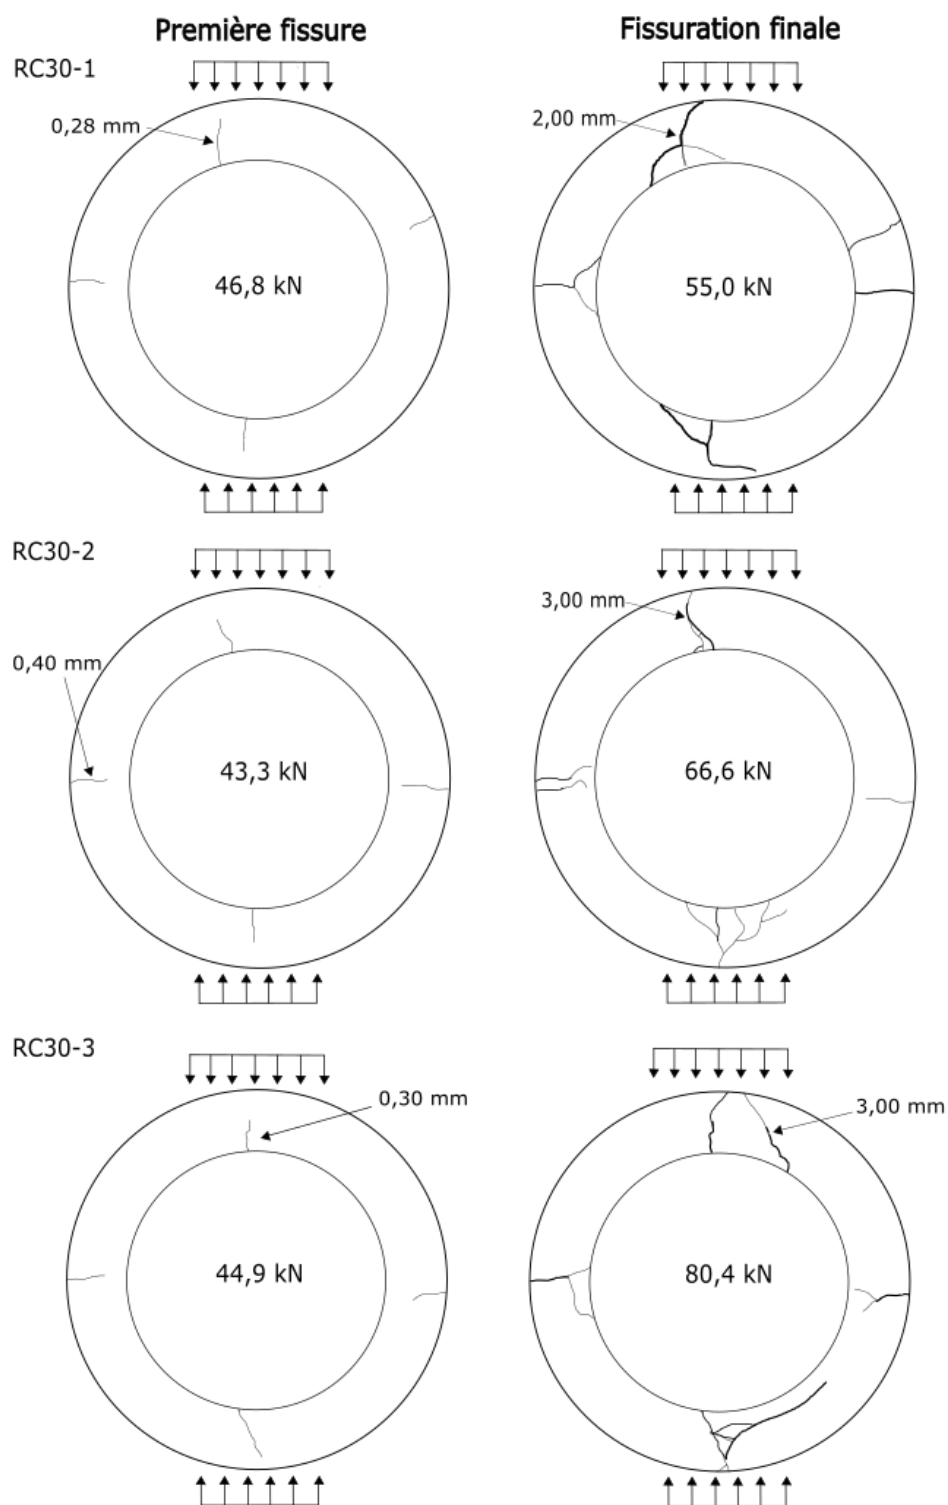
Premières fissures et fissuration finale des sections de tuyaux avec 30% de RB
